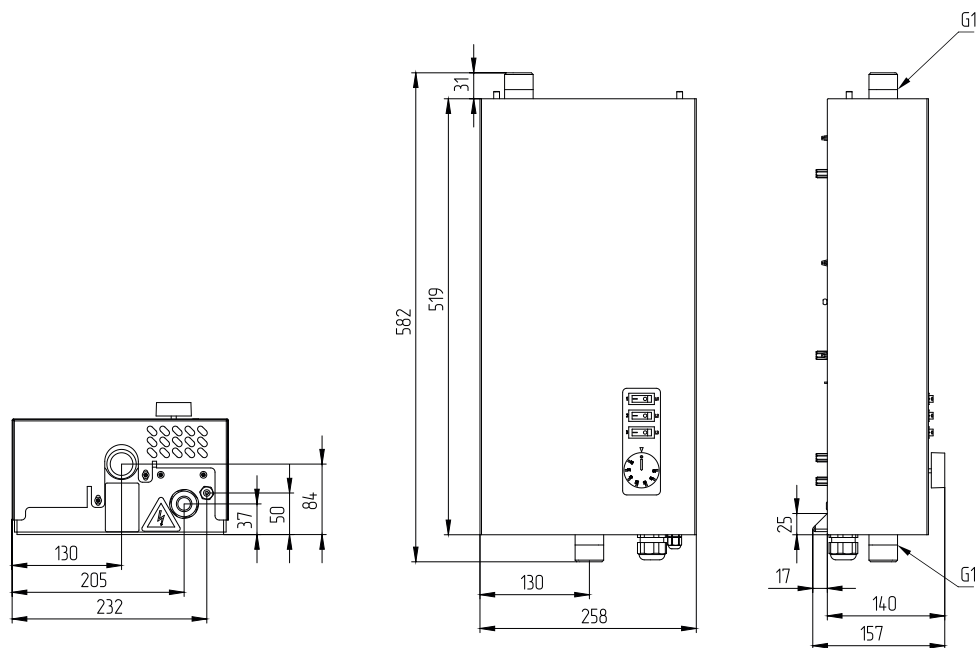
Габаритные размеры котлов ZOTA Balance 3 - 6 кВт
